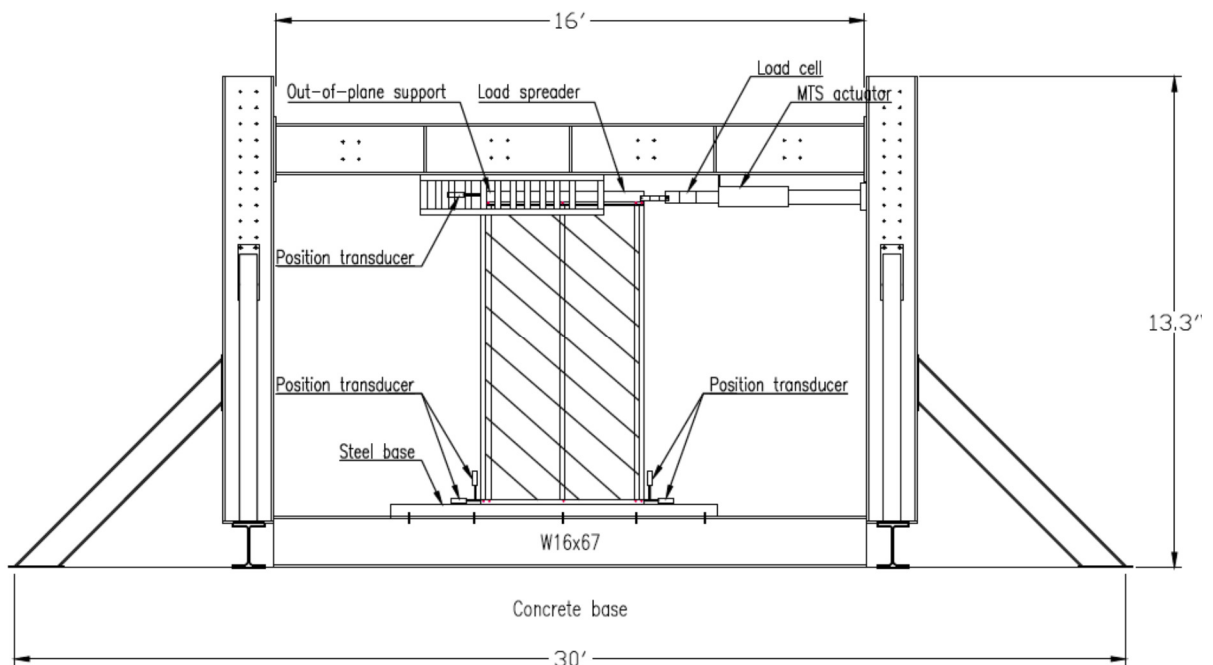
Detalhe do sistema de suporte fora do plano
